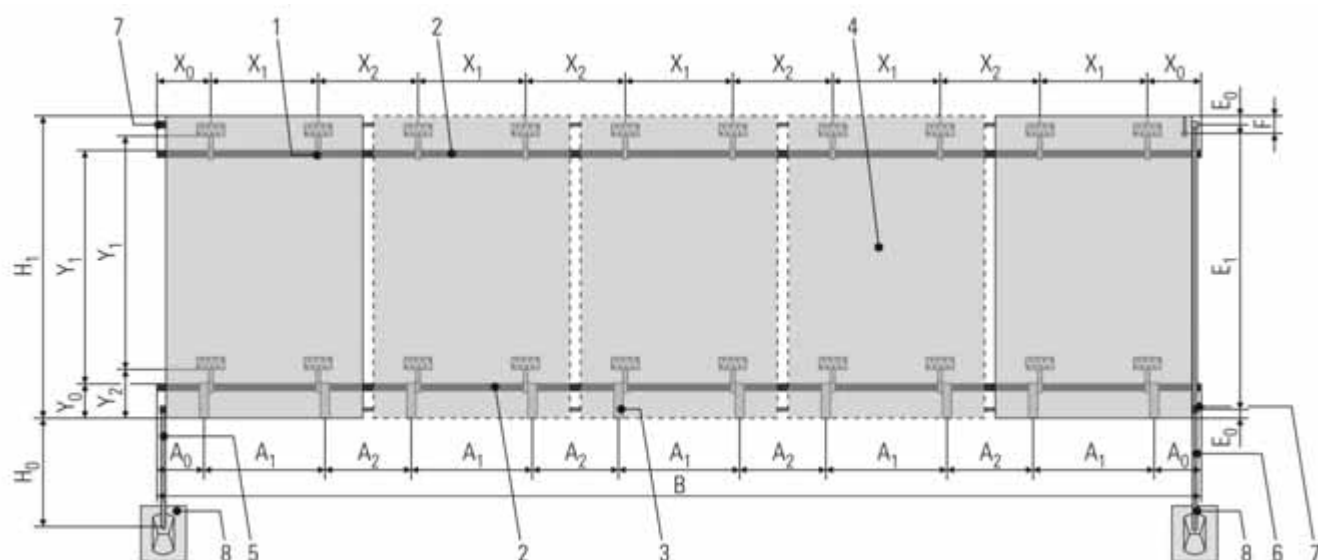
Dimensione principale di un campo di collettori Solaris per il montaggio su tetto (nel disegno, collettore V26A)
